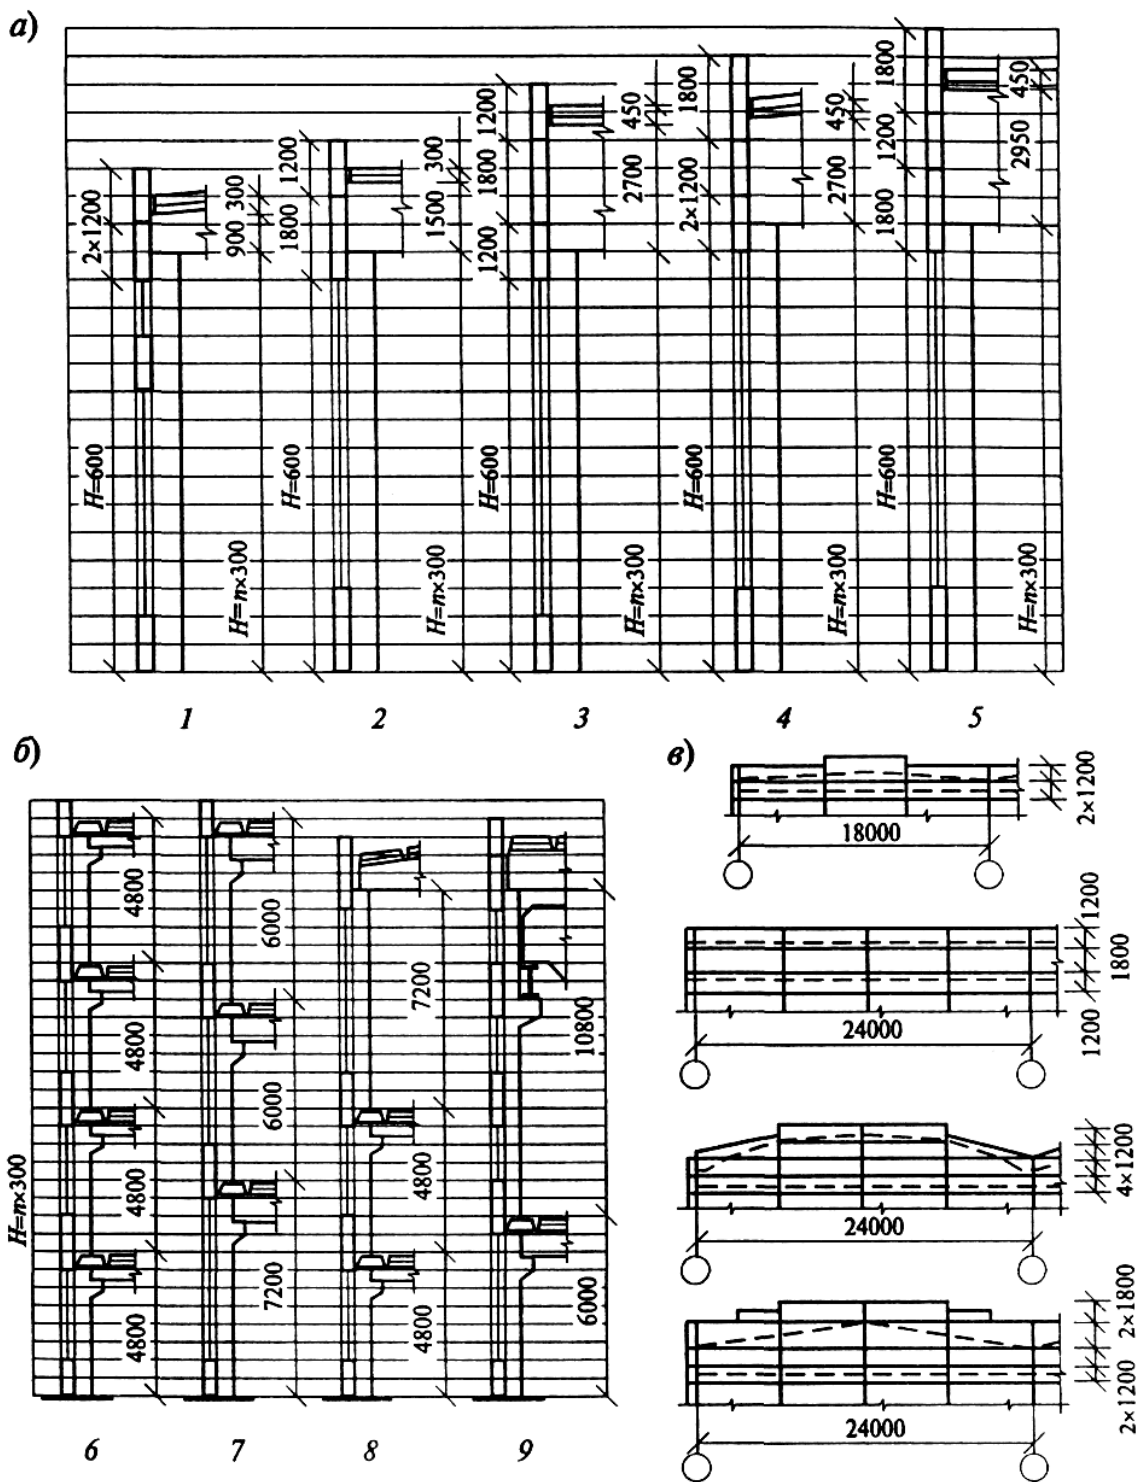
Схема раскладки панелей по условиям унификации:
